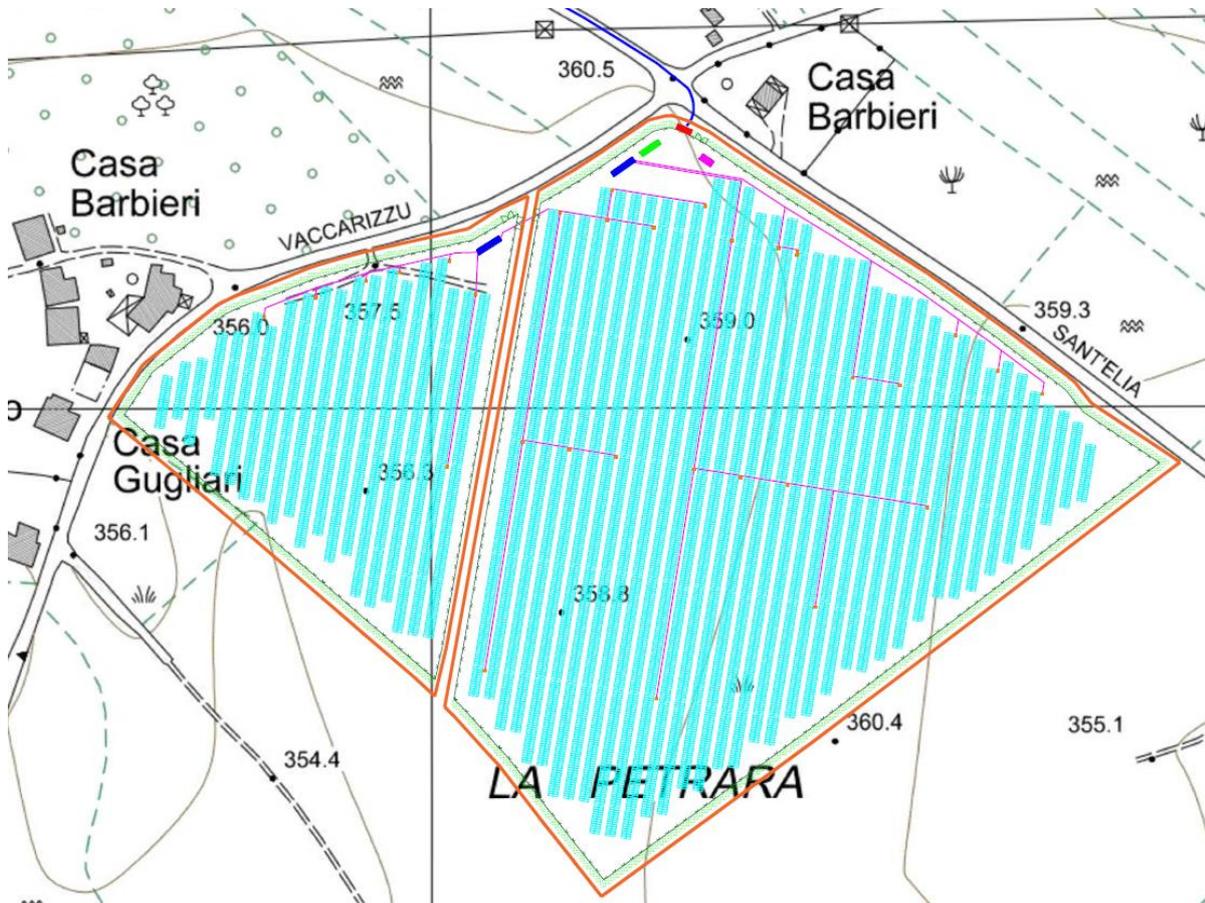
planimetria area impianto FV [stralcio dell' Allegato SRG-SNF-LO-03]
